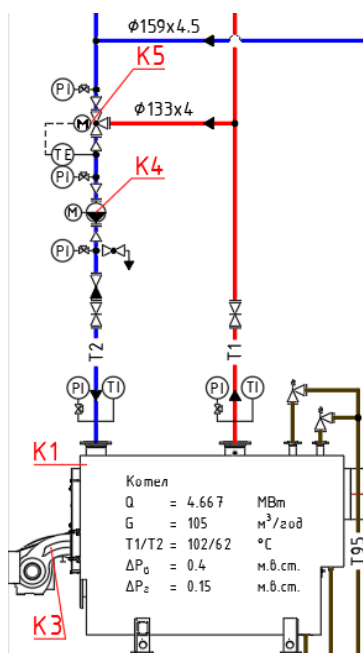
Принципова схема обв'язки одного котла Bosch
